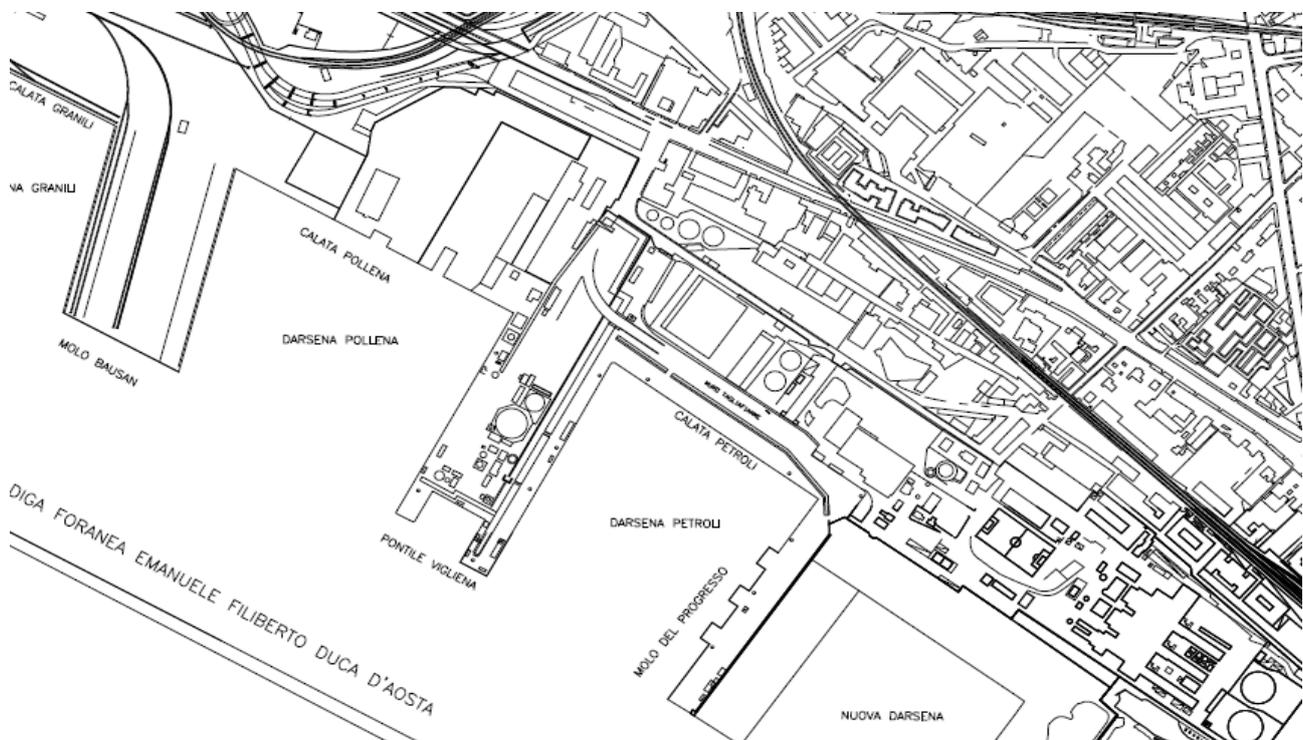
Individuazione planimetrica della Darsena Petrolri
